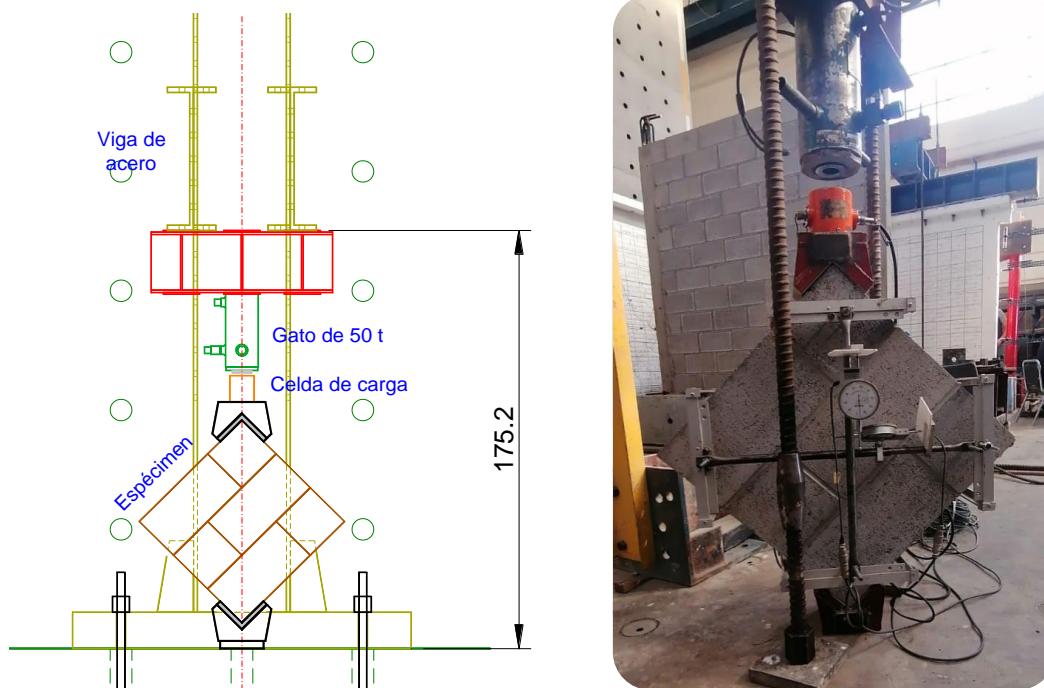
Probetas para ensaye a compresión y compresión diagonal de mampostería
